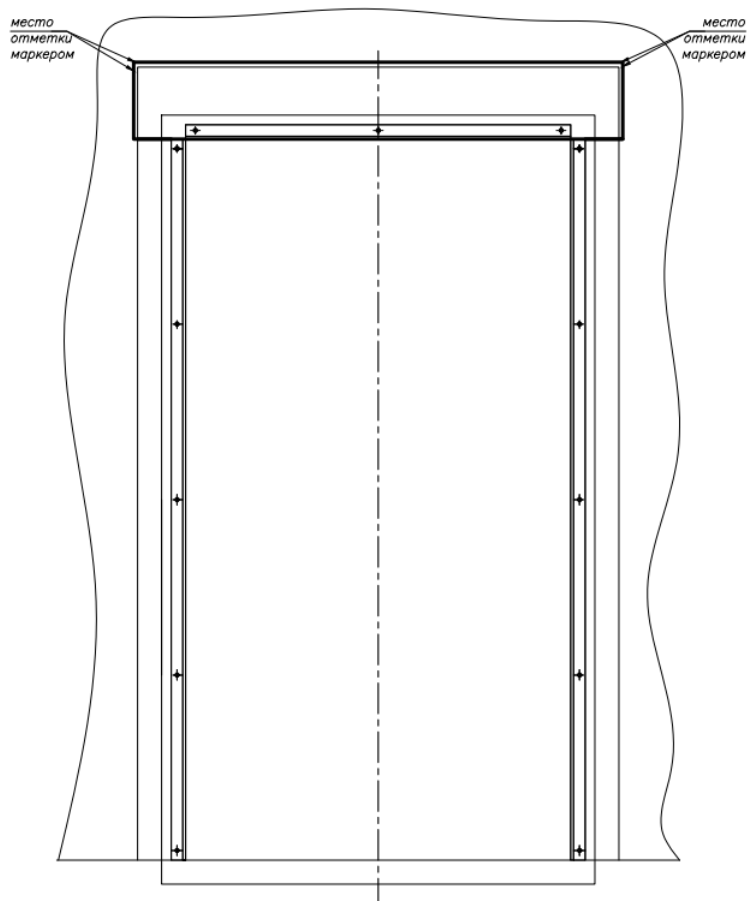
Разметка установки кронштейнов крепления верхнего обрaмления
